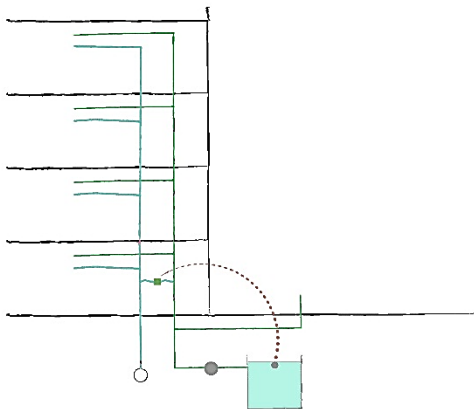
Conexión entre el sistema de agua potable y pluvial
